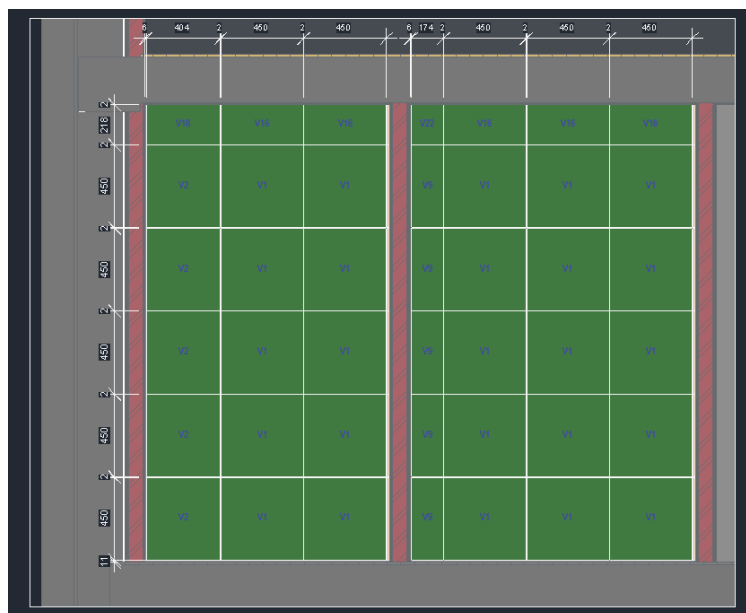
Corte anotado com todas as medidas de painéis, juntas, espaços entre painéis e outros elementos construtivos, marcas dos painéis e vista limpa
